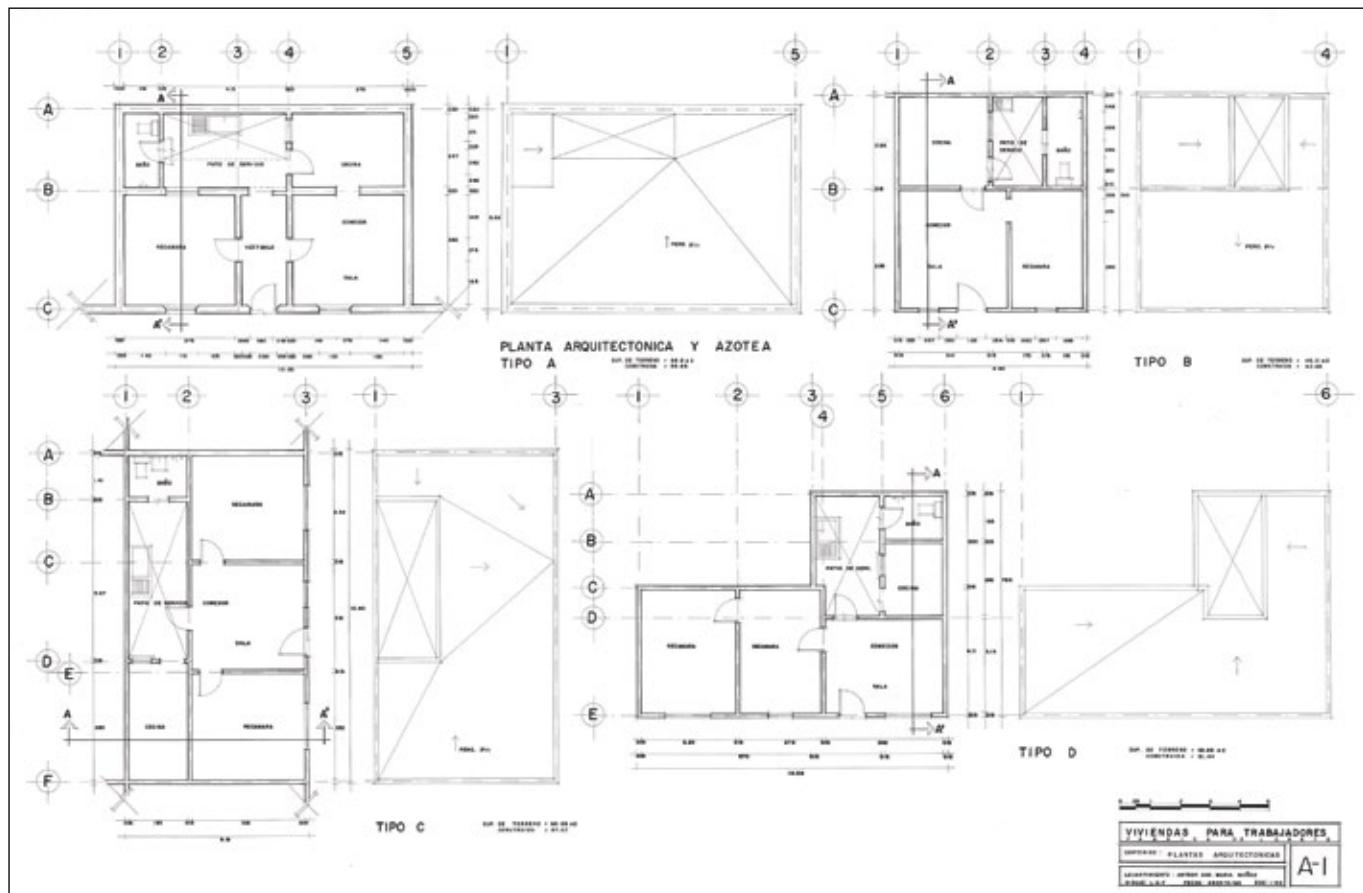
Plantas arquitectónicas de tipos de vivienda para trabajadores de Loreto (Dibujo: Laura Díaz Flores 1993).
